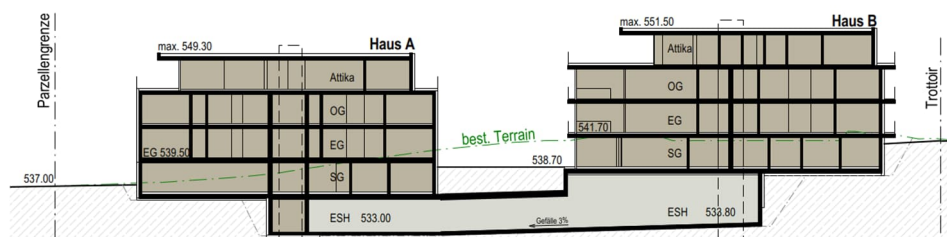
Schnitt gem. Gestaltungsplan Oberdorf, 2016
